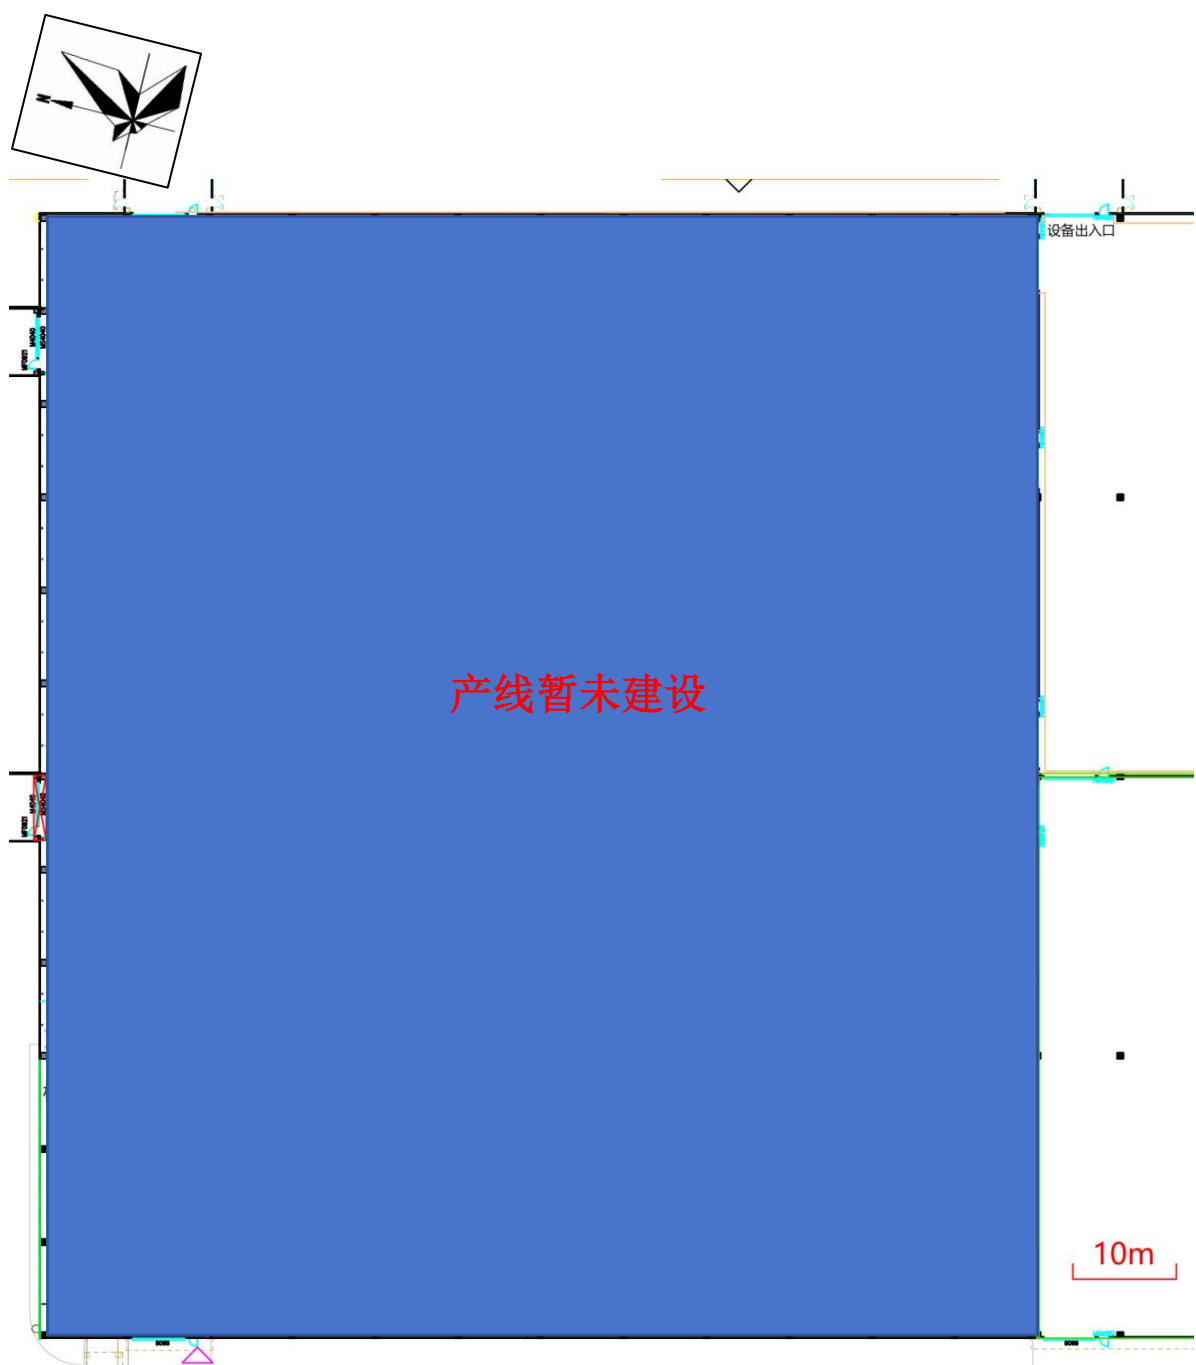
项目平面布置图（厂房 3-1、厂房 3-2）
